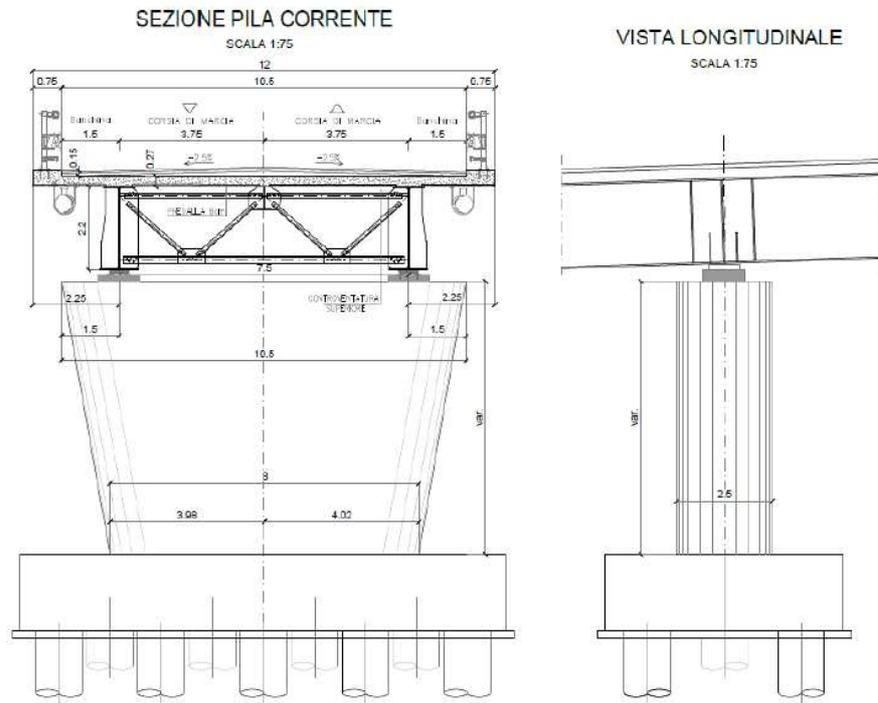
Viadotto A14 – Sezione tipo su pila
